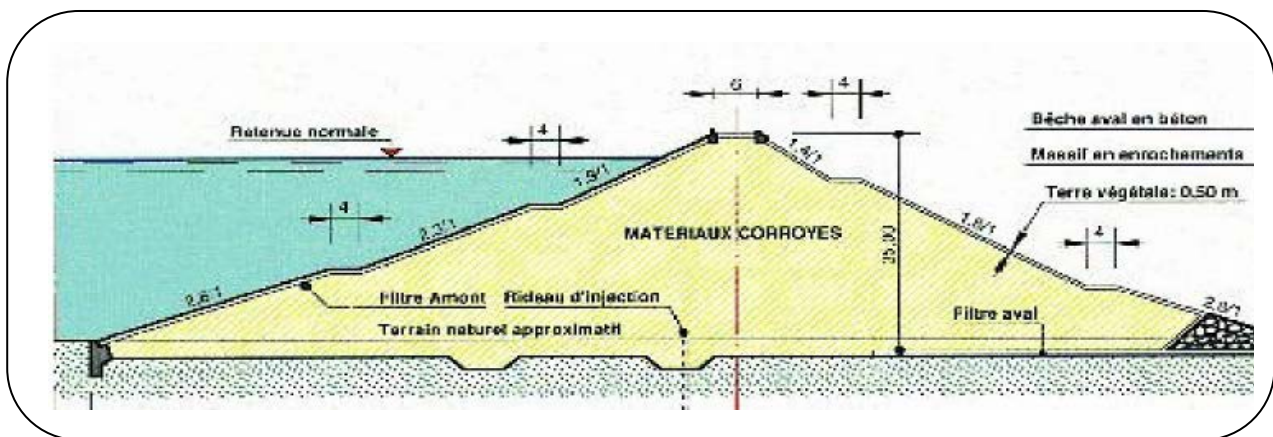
coupe d'un barrage en remblai Barrage zones [2]
